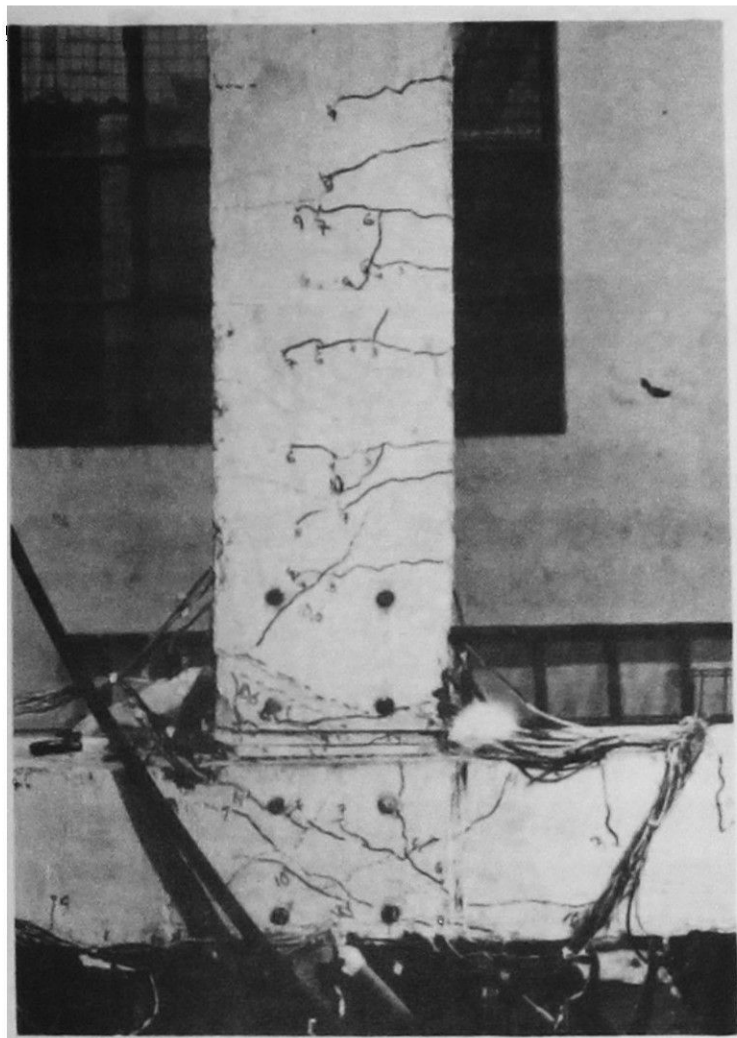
Estado de la probeta 2 cuando la viga alcanza el momento último.
